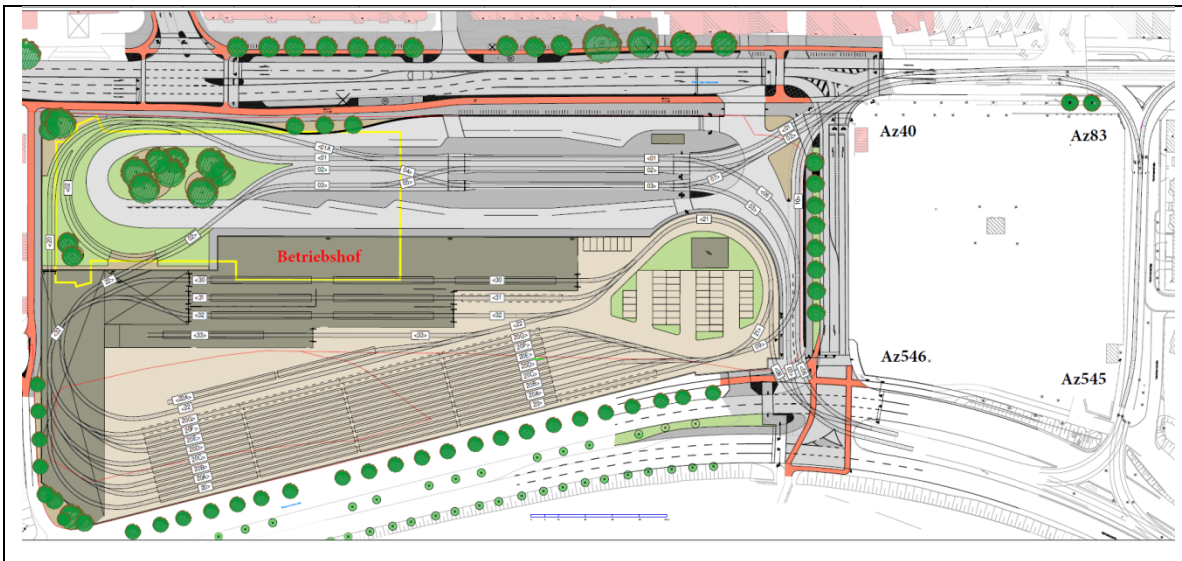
Neu- und Umbauplanung Betriebshof Gröpelingen Vorentwurf Lageplan
